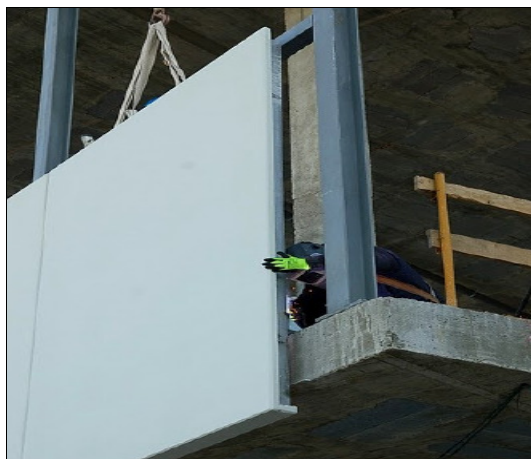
Vista de la colocación de paneles "Stud-Frame".
